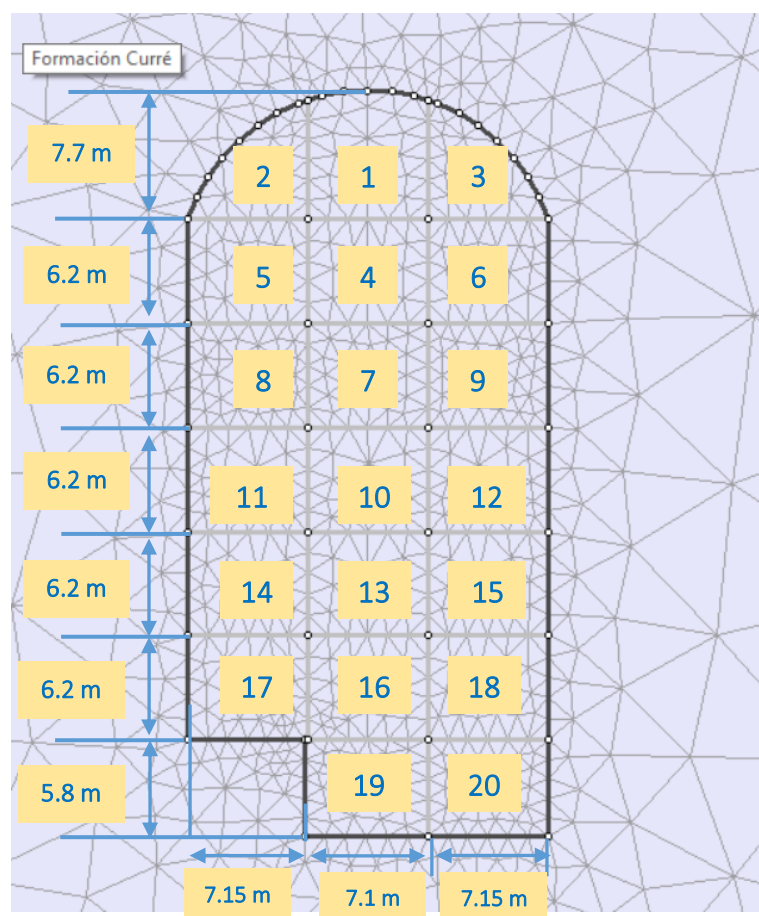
Secuencia constructiva propuesta para la caverna con secciones no uniformes.
